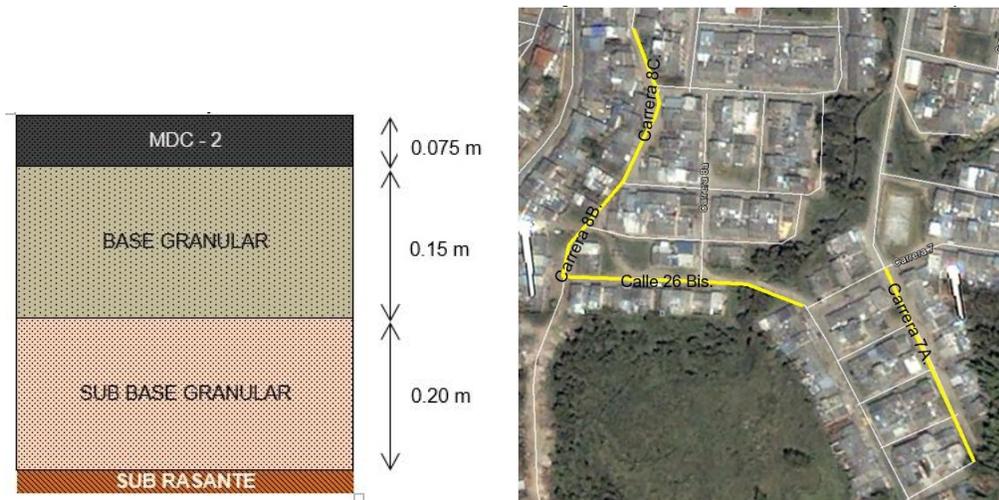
Movimiento de tierras. Estructura de pavimento Barrio Nuevo Japón.
